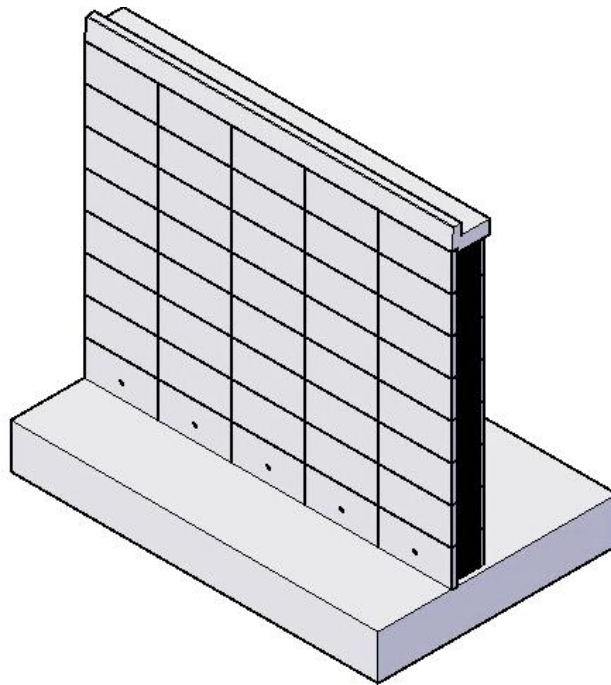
Vista 3D muro $H=8,0m$ con paneles rectos (Frente)
